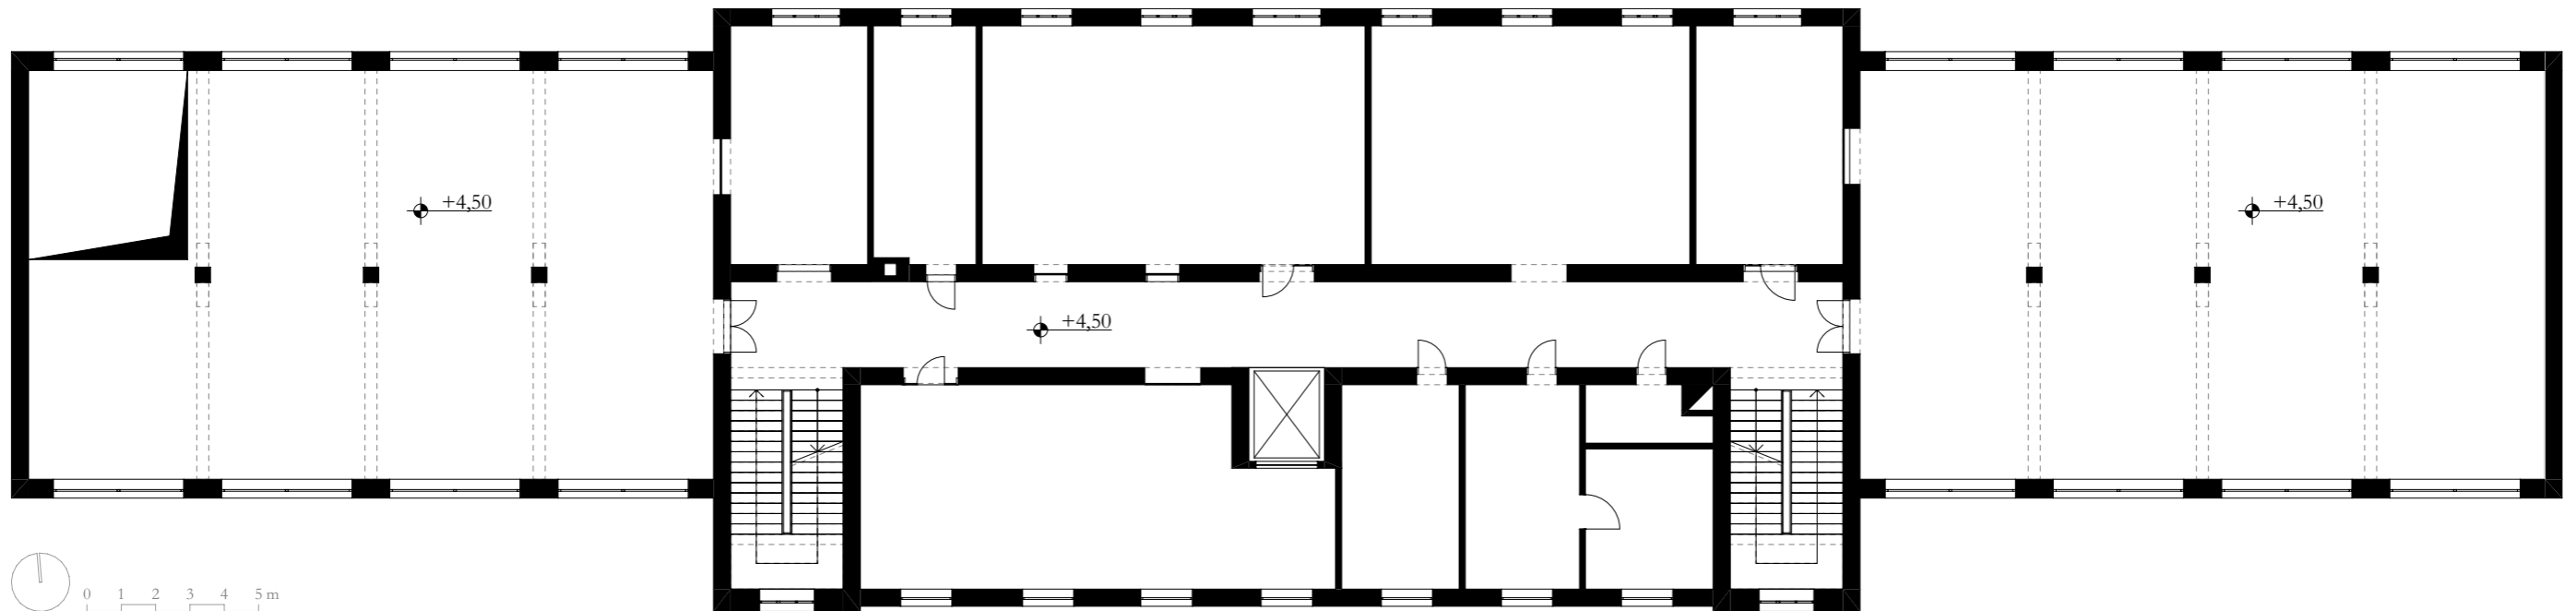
Grundriss Bestand Obergeschoss M 1:200
